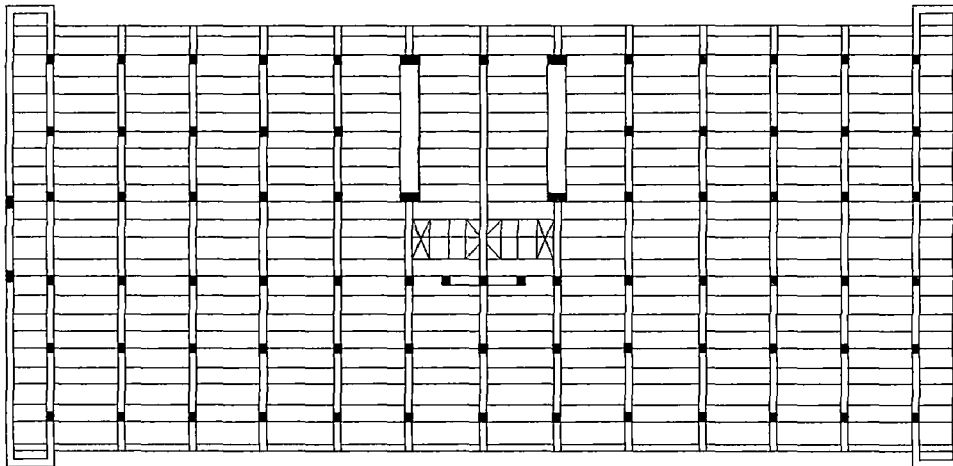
Esquema de Planta Típica del Techo de un Campamento minero
